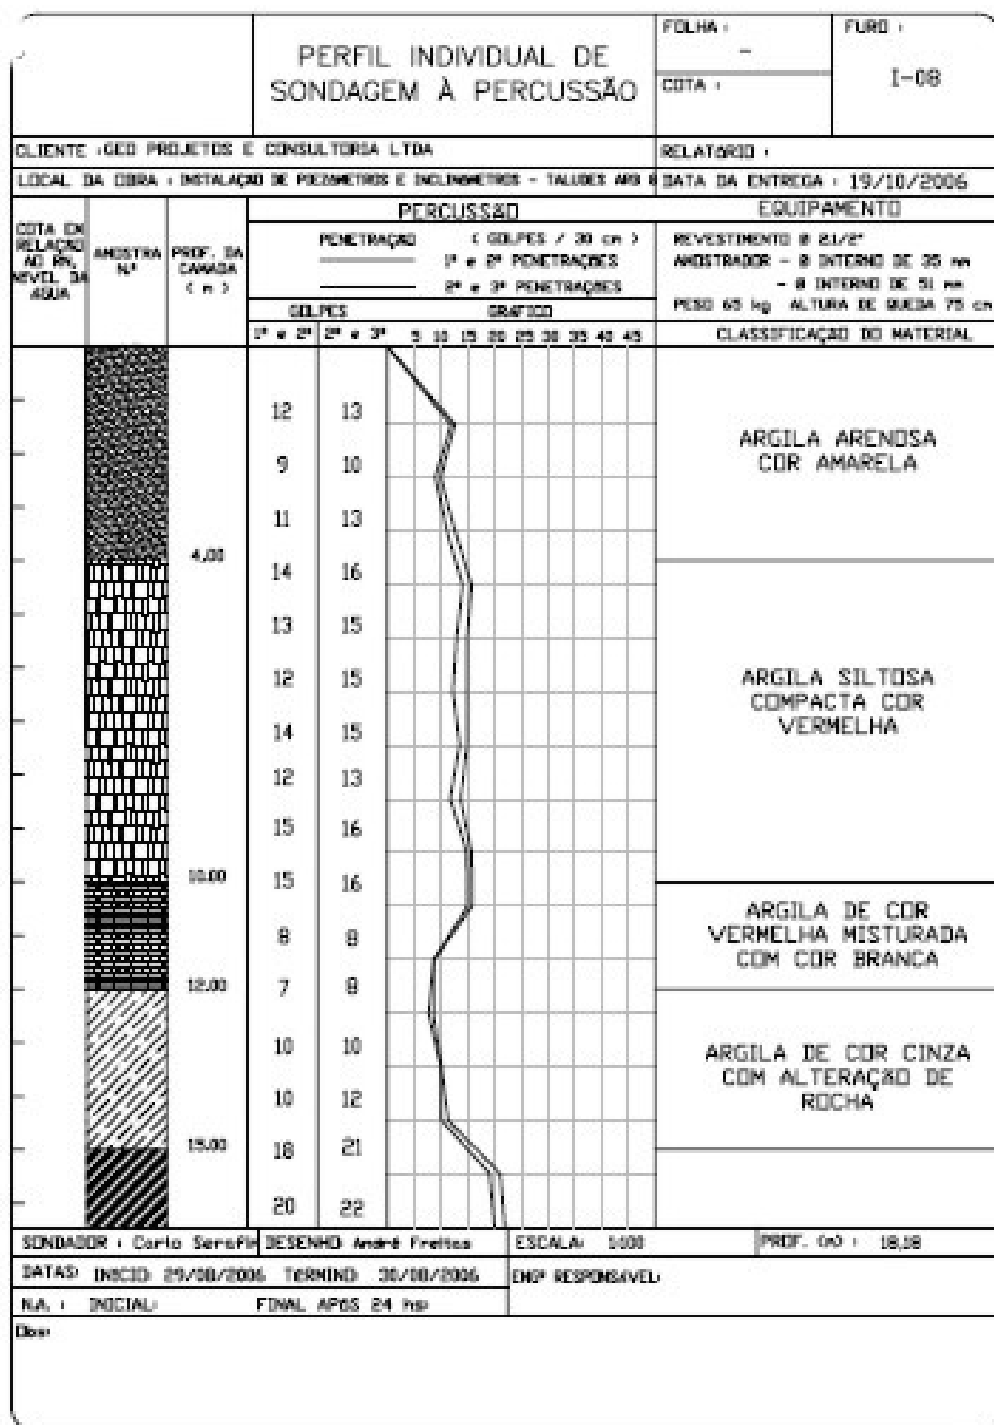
Perfil de sondagem do furo do inclinômetro I-8.
